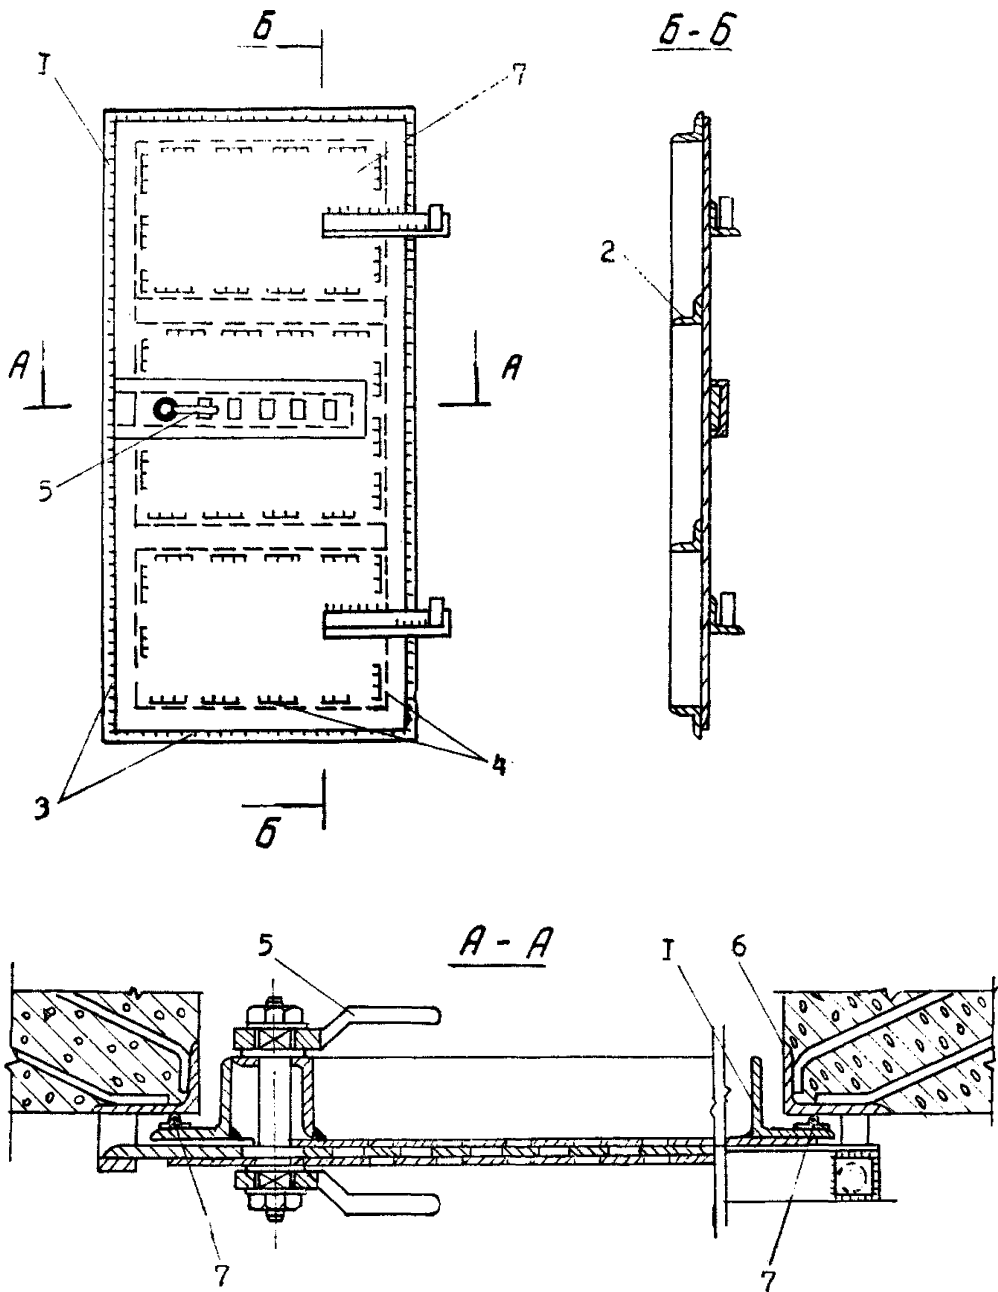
Герметическая металлическая дверь с кассетным клапаном: 1 — уголок двери; 2 — ребра жесткости; 3 — сплошной сварной шов; 4 — прерывистый сварной шов; 5 — клапан-рукоятка; 6 — коробка из уголка; 7 — фасонный резиновый уплотнитель.
